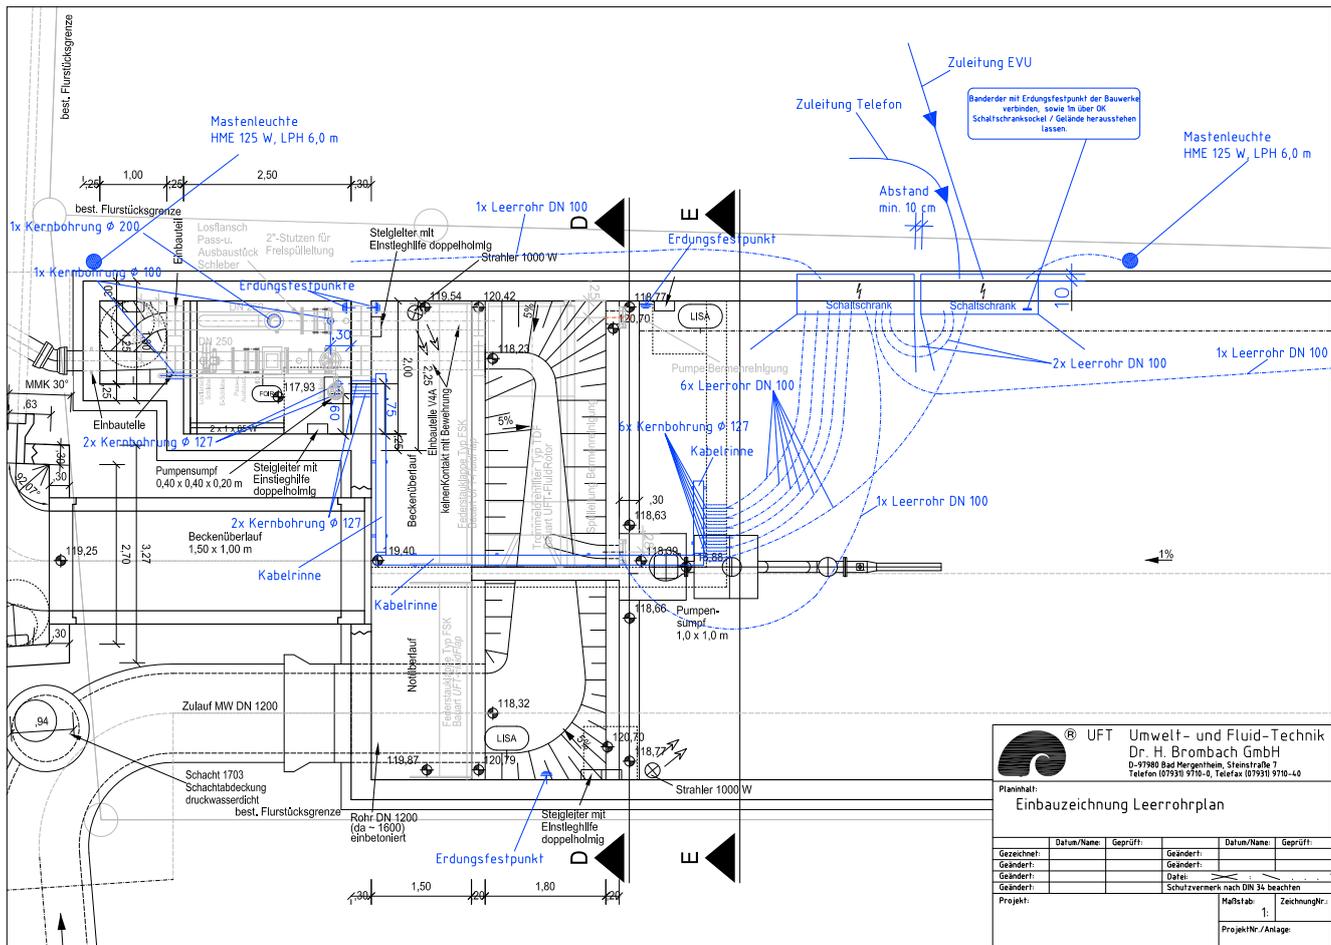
Ausschnitt aus einem Leerrohrverlegeplan
